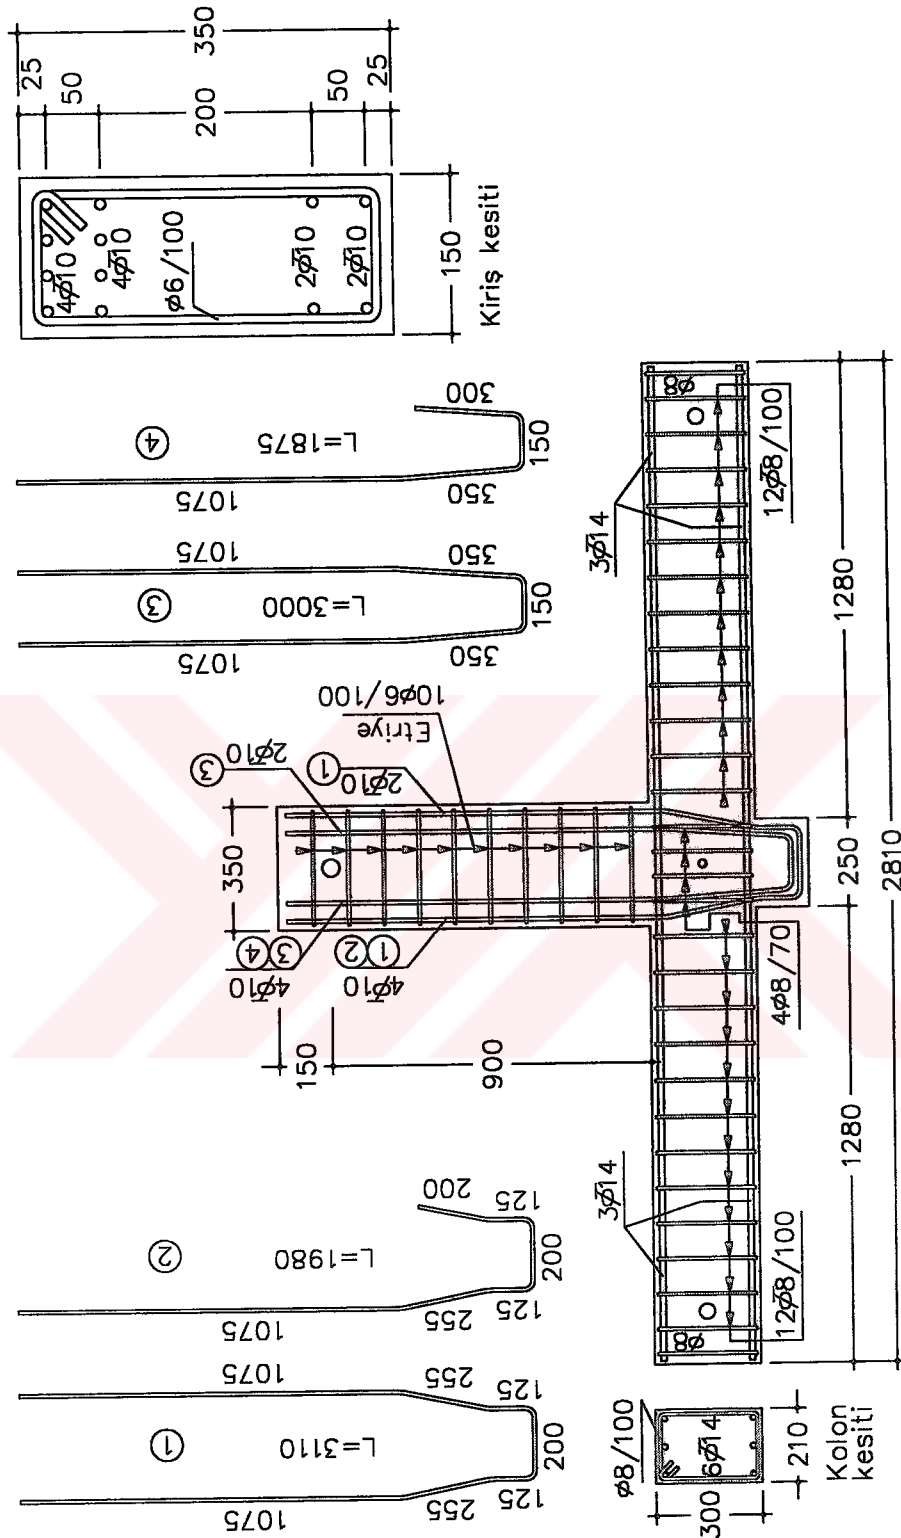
BC5 elemanın boyut ve donatı detayı
